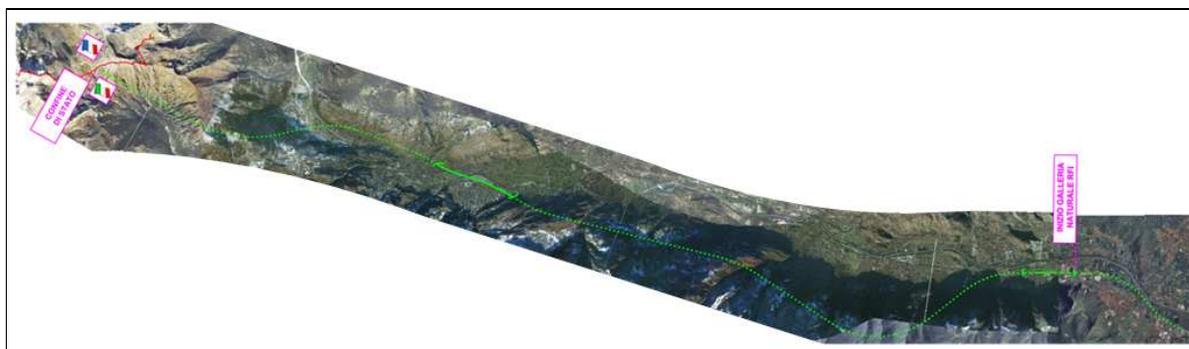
Schema complessivo del tracciato di progetto su ortofoto
